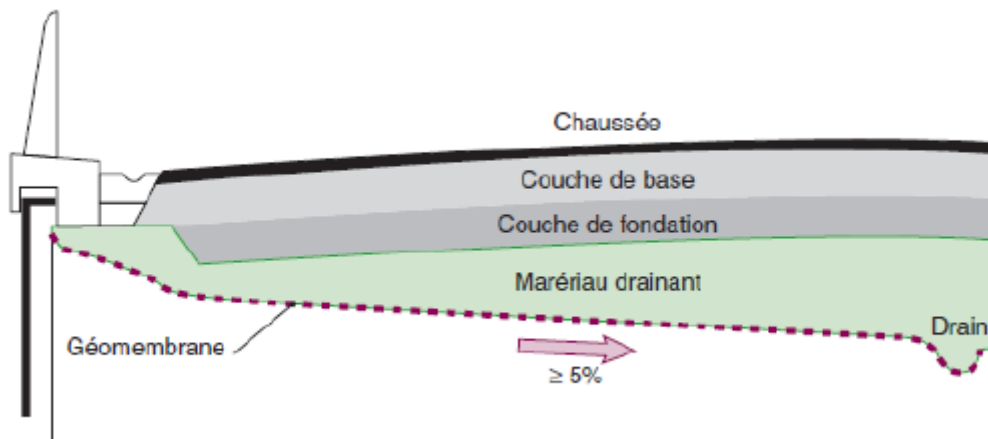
15 : Exemple d'une protection contre les eaux de ruissellement (LCPC, 2003).
